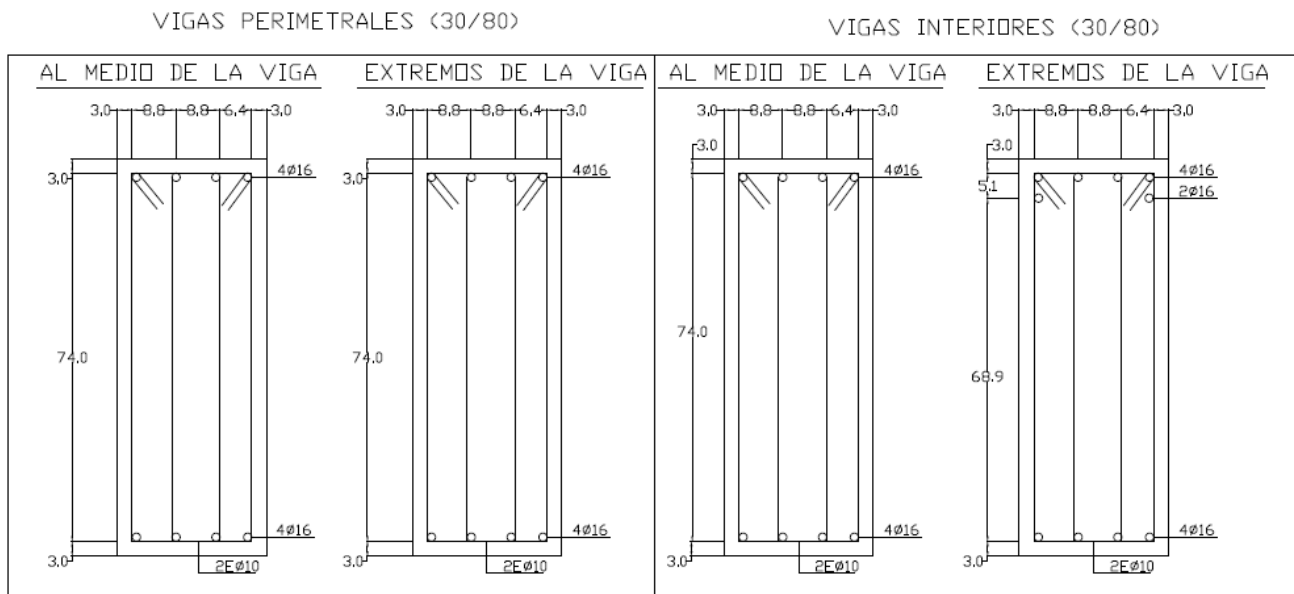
Sección transversal de las vigas del piso 4 de la estructura aislada
